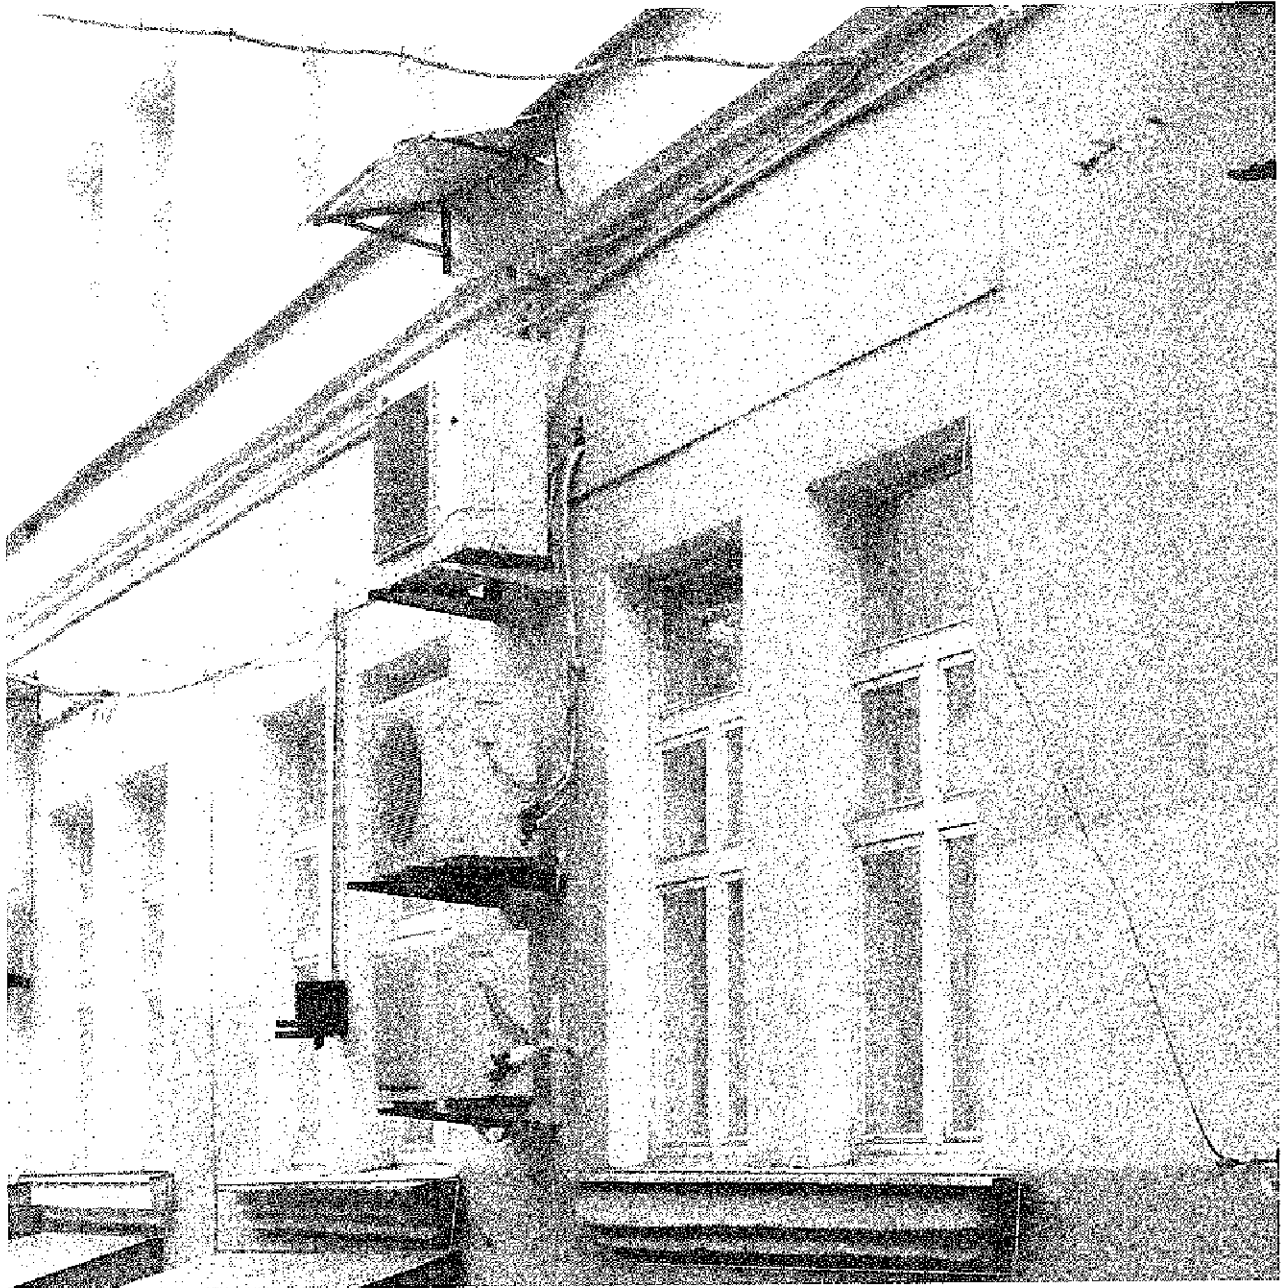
Профилированные подоконные карнизы, 1-й этаж. Восточная часть северного фасада здания. Дата: 14.07.2021
